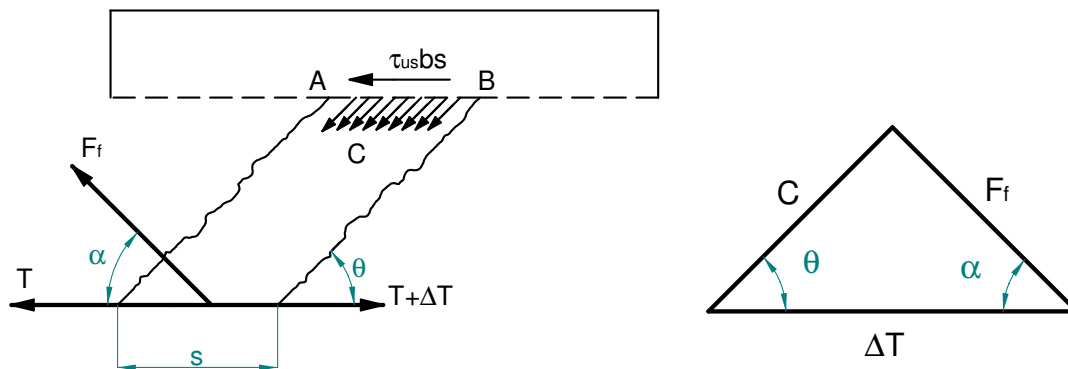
Trozo de viga entre dos fisuras y triángulo de fuerzas
